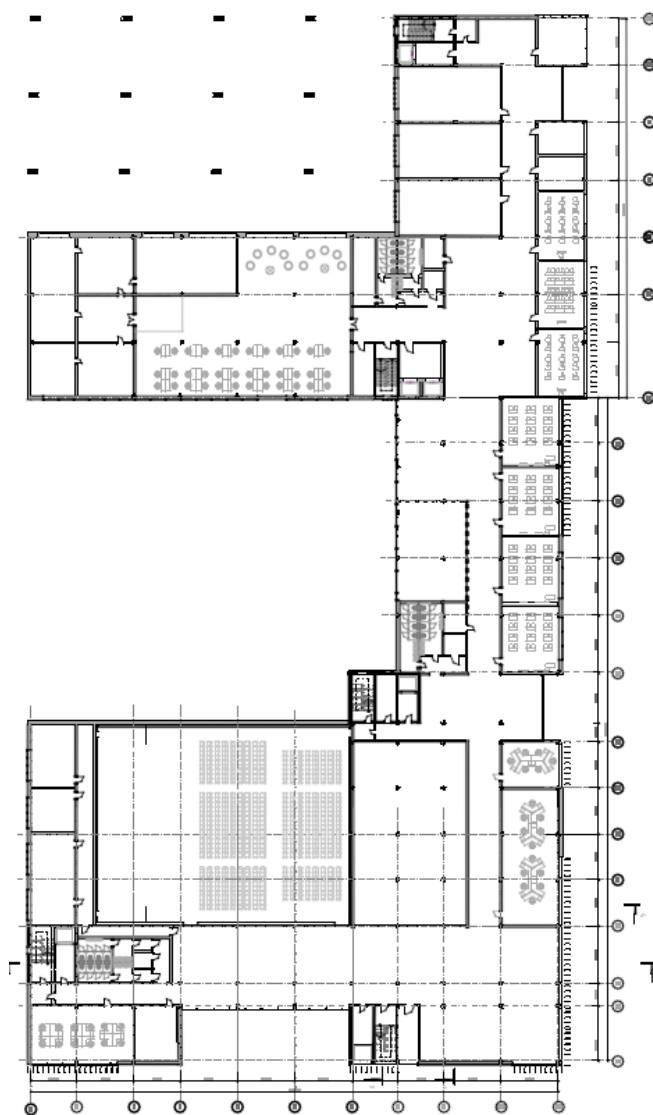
План другого поверху (на відмітці +3.900)
